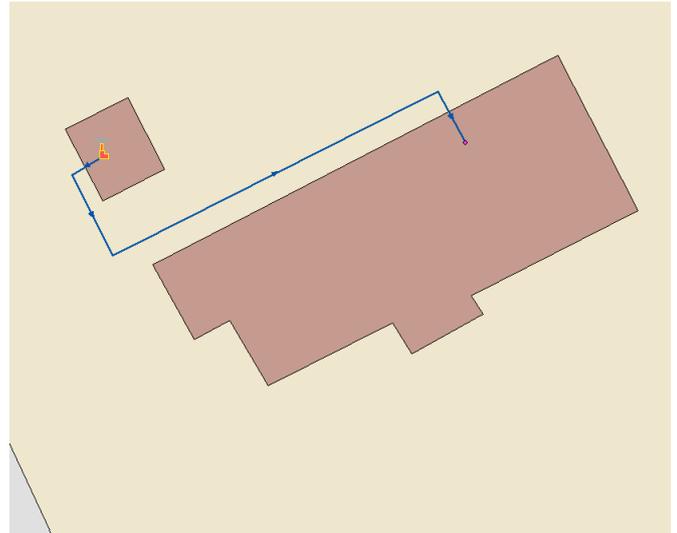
Схема тепловых сетей от здания котельной ул. Рубежная, дом №7
